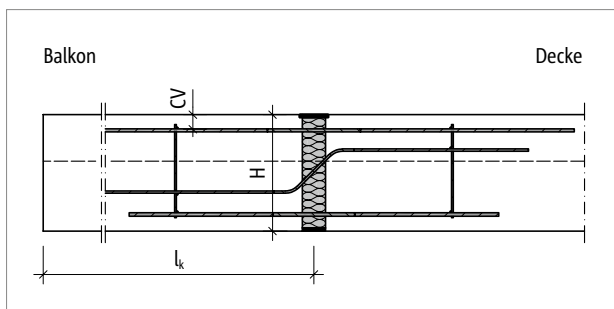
Schöck Isokorb® T Typ B: Statisches System
